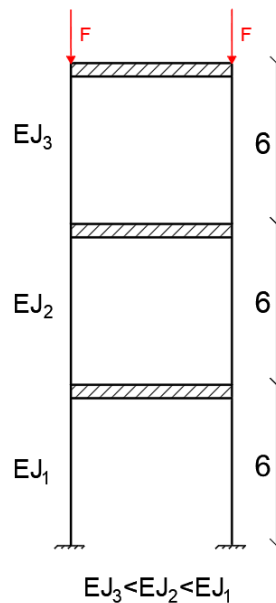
Schema Telaio multipiano a sezione variabile
